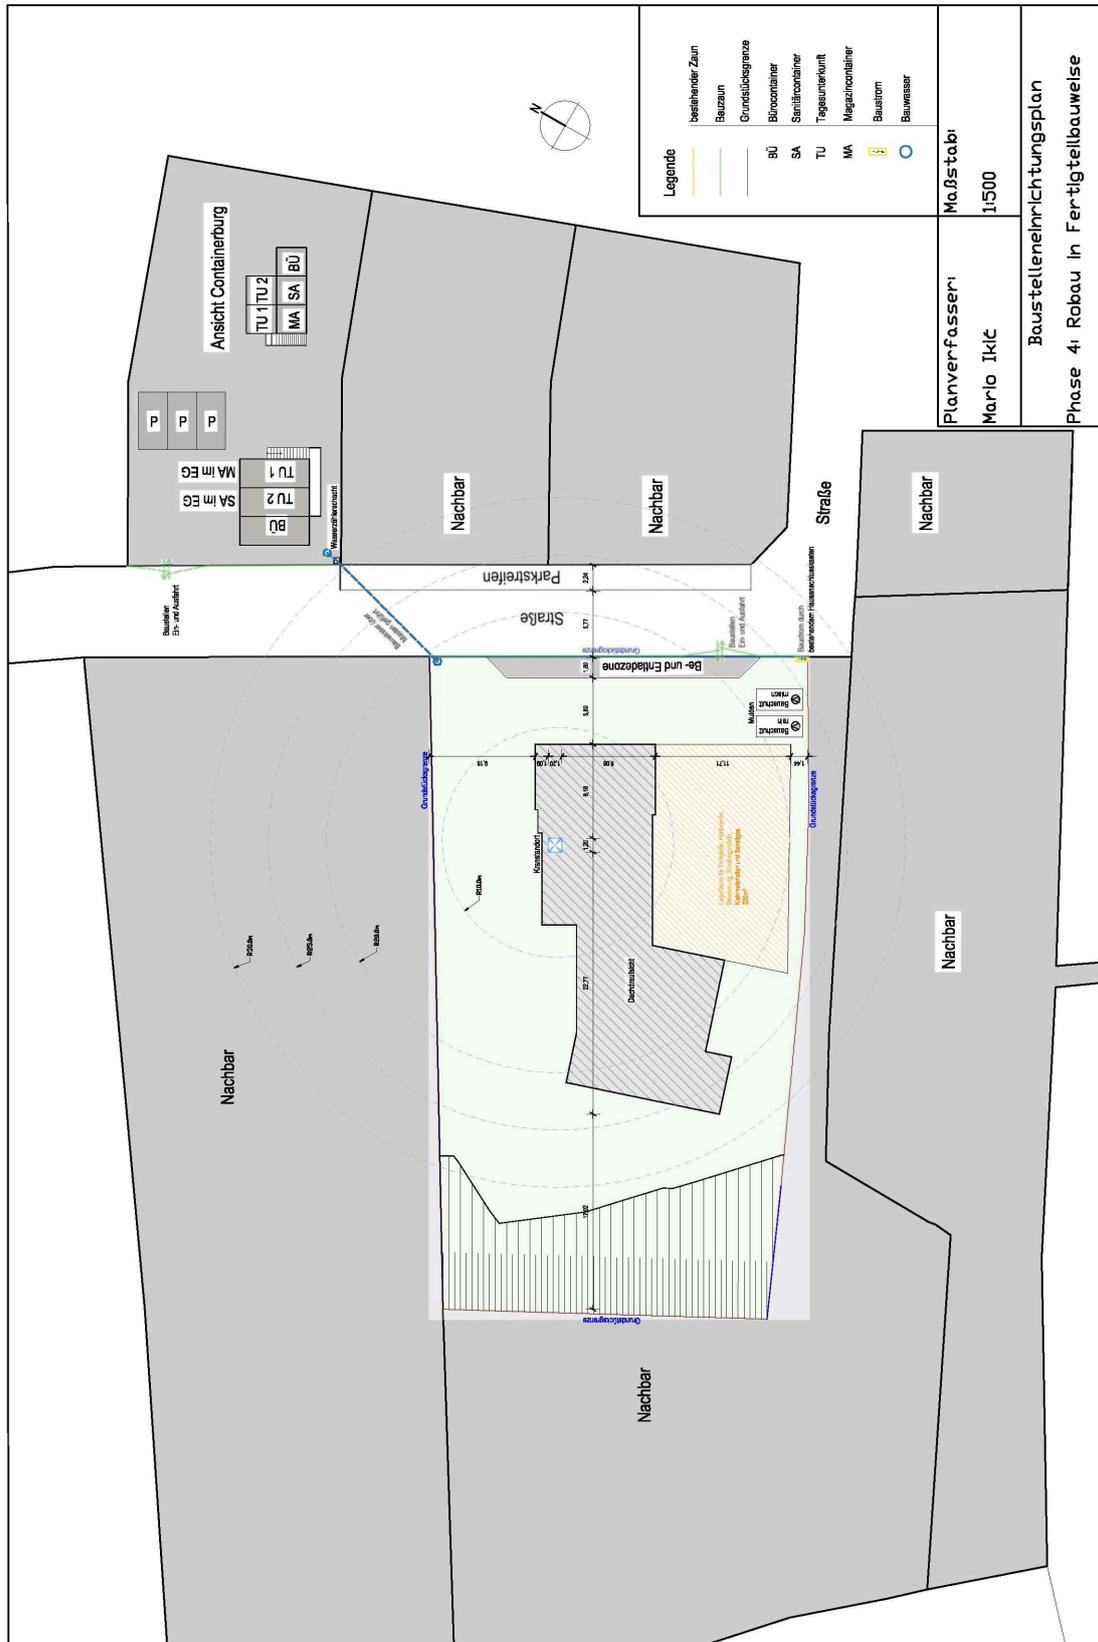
Baustelleneinrichtungsplan für Bauphase 4
